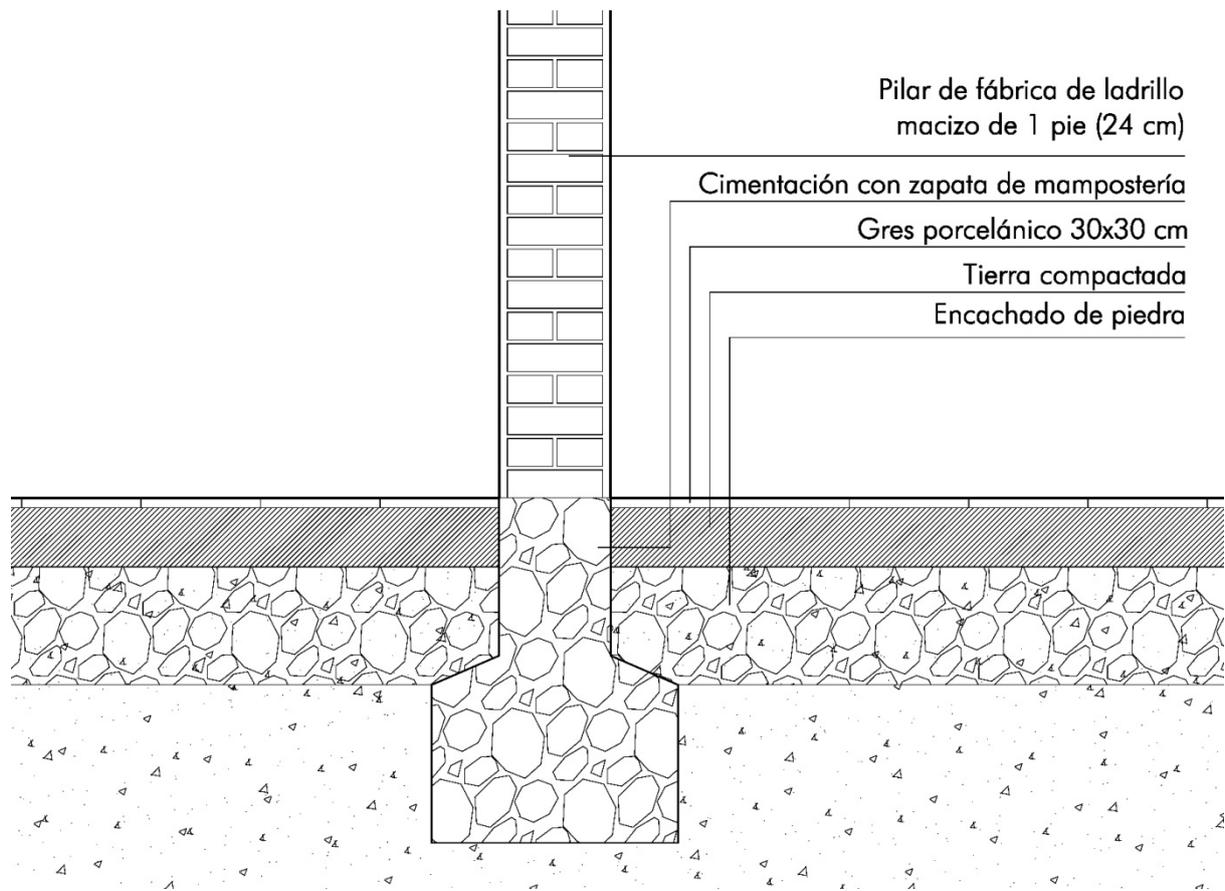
Detalle cimentación pilares aislados. Fuente propia. Anexo II plano nº 6
